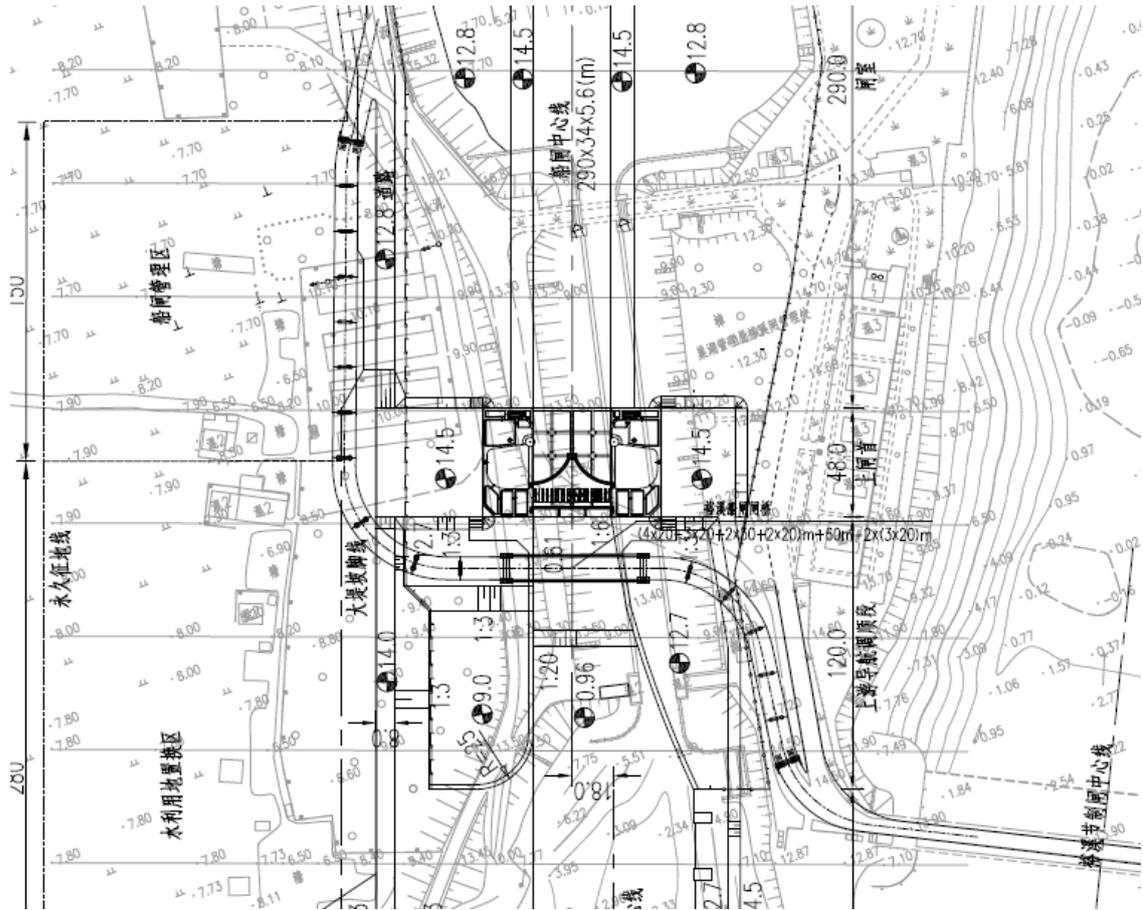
改建桥梁与节制闸桥共建方案平面布置图
